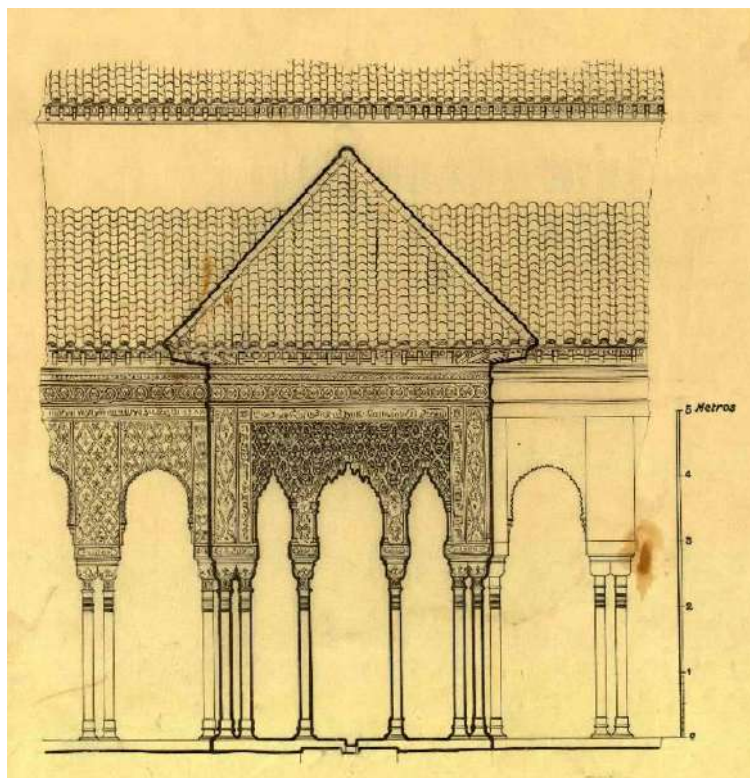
Propuesta de restauración de la cubierta del templete de levante del Patio de los Leones. Manuel López Bueno (delineante), Torres Balbás, 1929. (APAG/ Colección de Planos/ P-000162).
